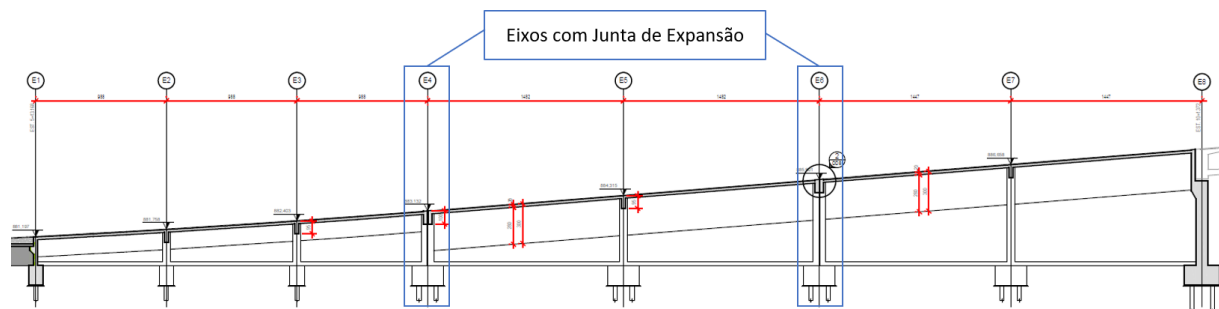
ELEVACÃO ENCONTRO ESTRUTURADO (EIXOS E1 A E8)
